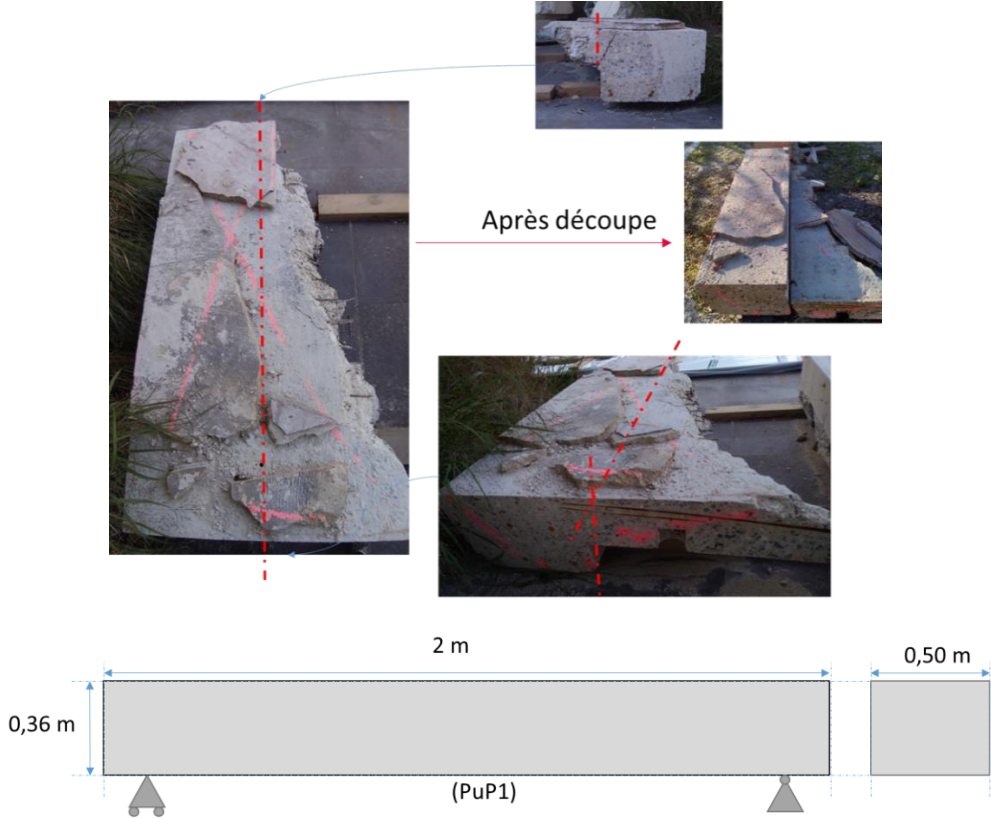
présentation de la poutre PuP1 (chantier de Paris)
